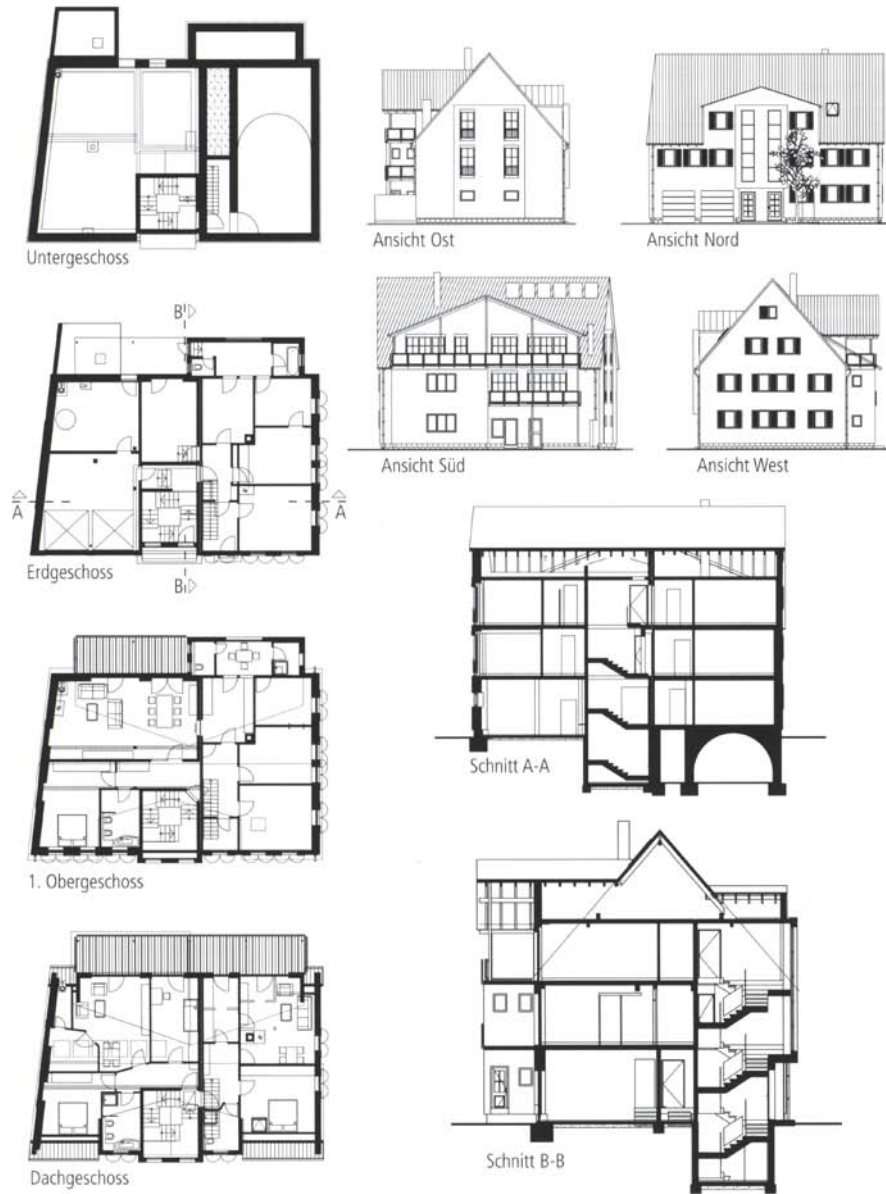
Grundrisse, Ansichten und Schnitte⁴¹⁶
